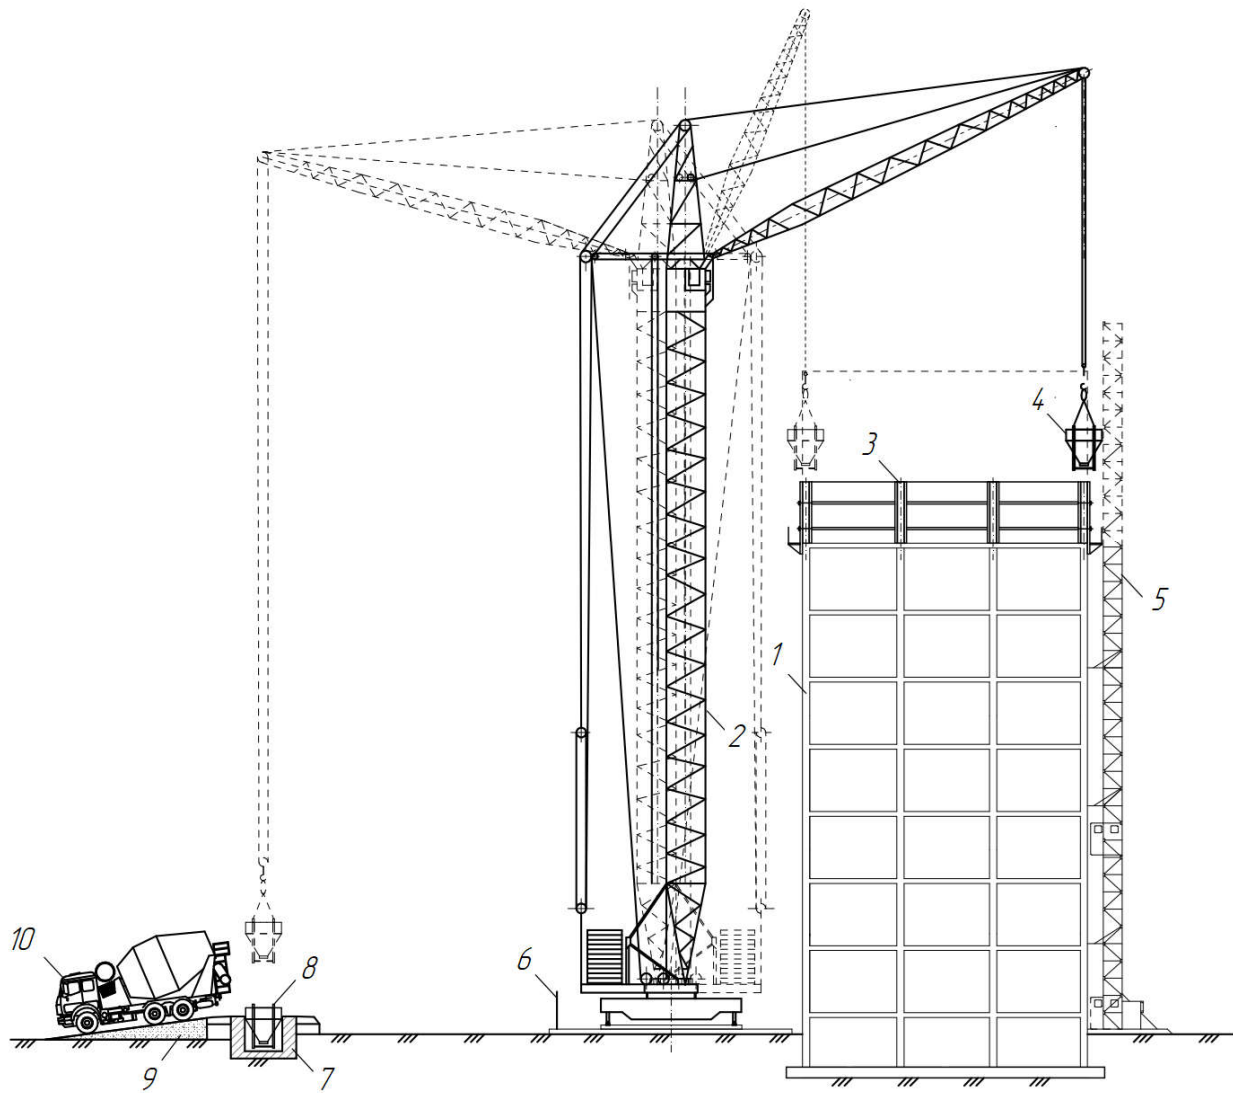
Схема бетонирования стен многоэтажного здания: 1 – возводимое здание; 2 – башенный кран; 3 – опалубка; 4 – неповоротный бункер; 5 – грузопассажирский подъемник; 6 – ограждение подкрановых путей; 7 – приямок для загрузки бункера; 8 – бункер при загрузке; 9 – въездной пандус; 10 – автобетоносмеситель
